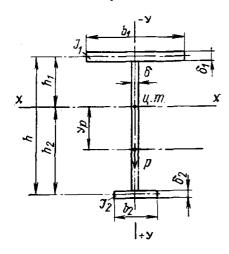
Поперечное сечение балки с развитым верхним поясом
